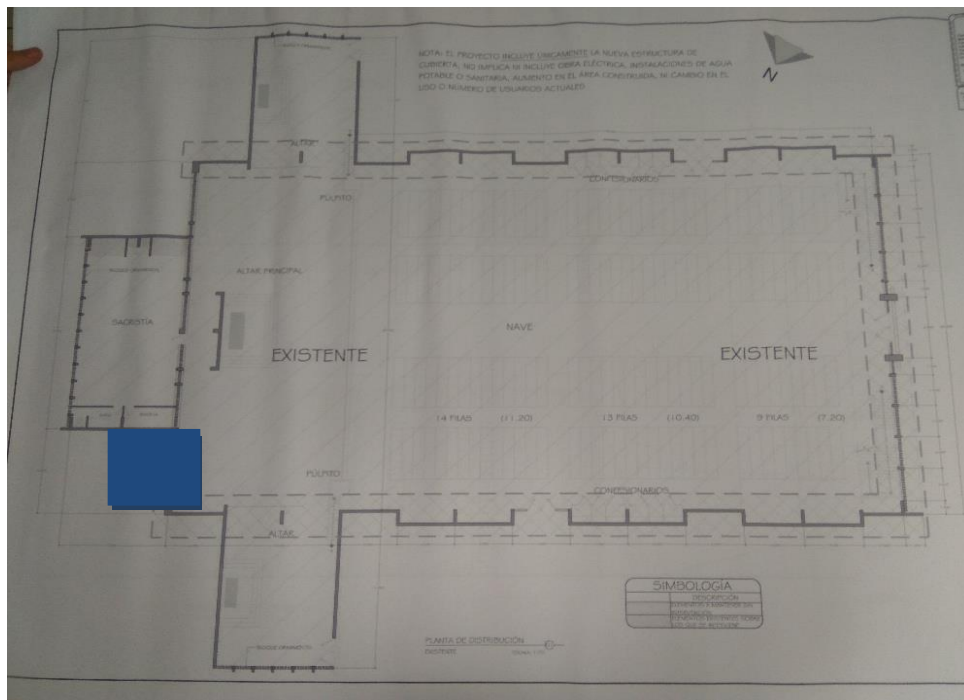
Área en planta para la instalación del tanque de almacenamiento
